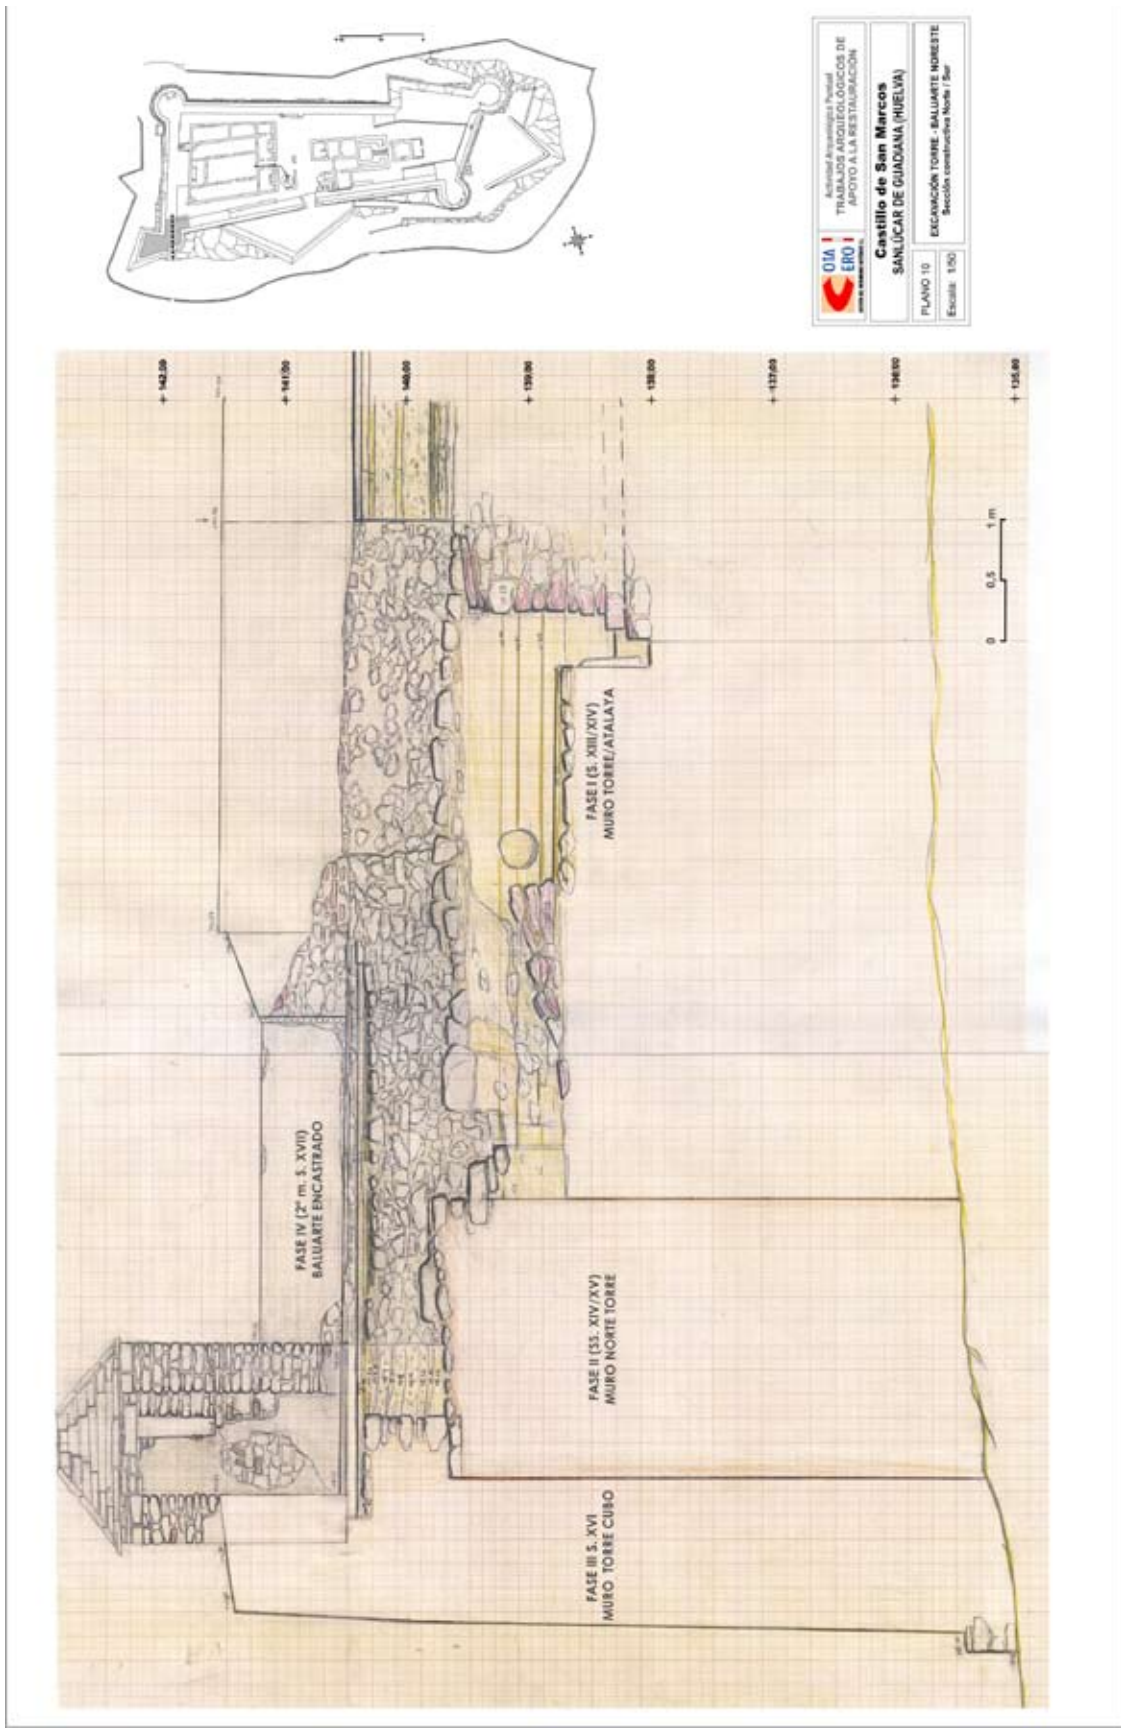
Excavación de la torre- Baluarte Noreste. Sección constructiva Norte – Sur.
